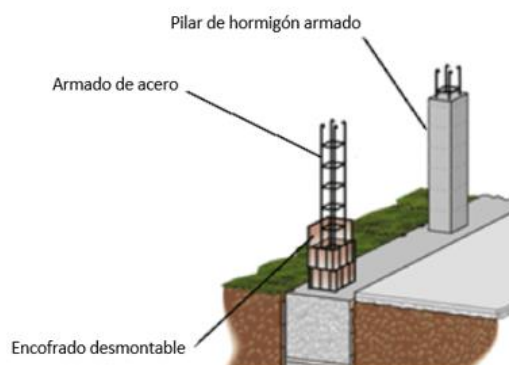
Elaboración de una columna de hormigón armado (10).
